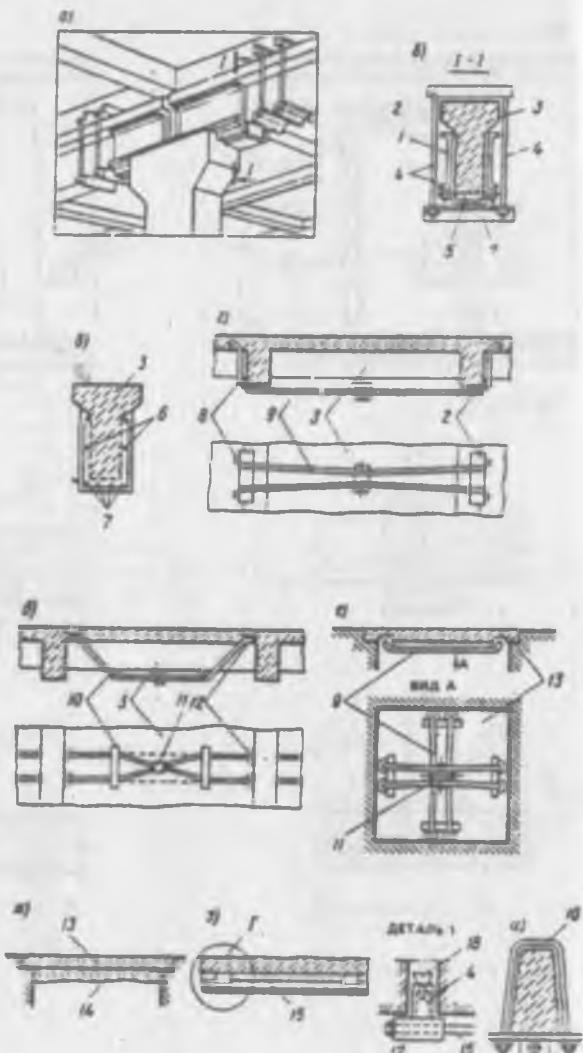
И Схемы усиления балок и плит перекрытий в покрытых [23].
